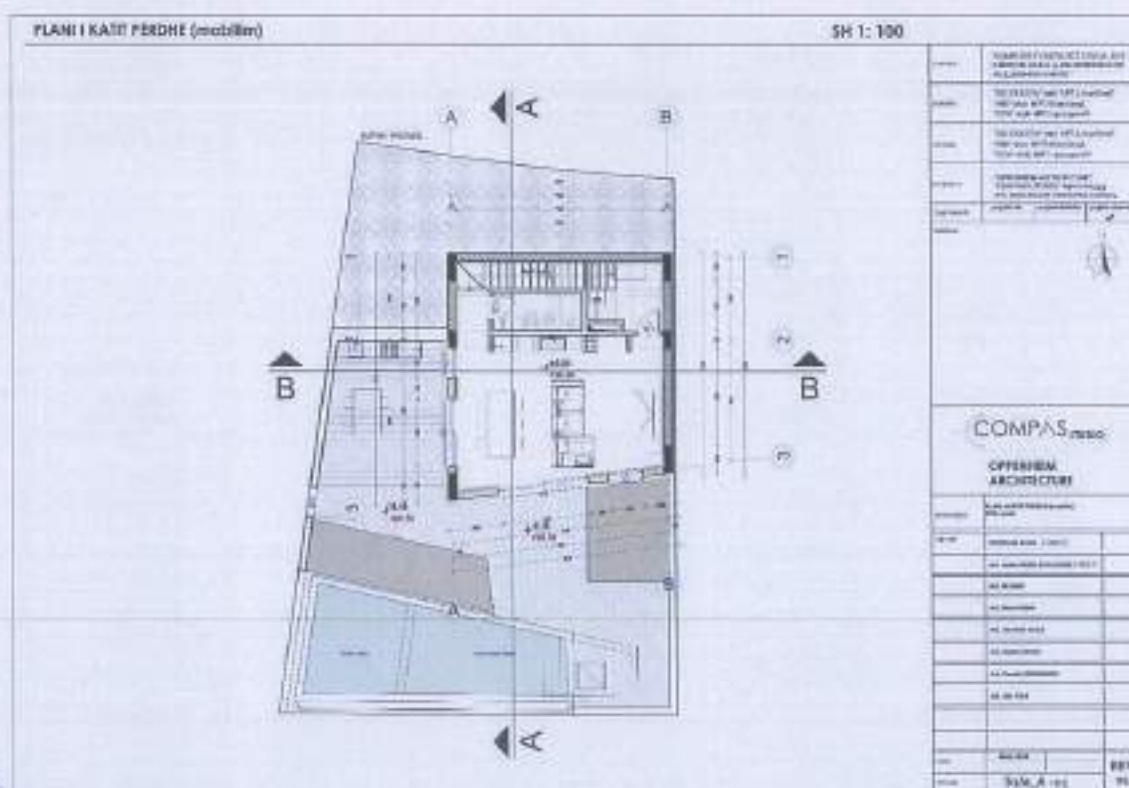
Vila S2/a \_ Planimetria e katit përdhe
